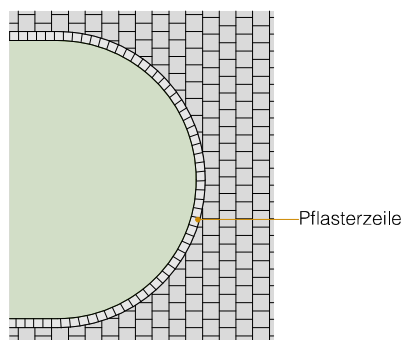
Schema für Einfassung einer Grünfläche mit geschwungener Pflasterzeile
